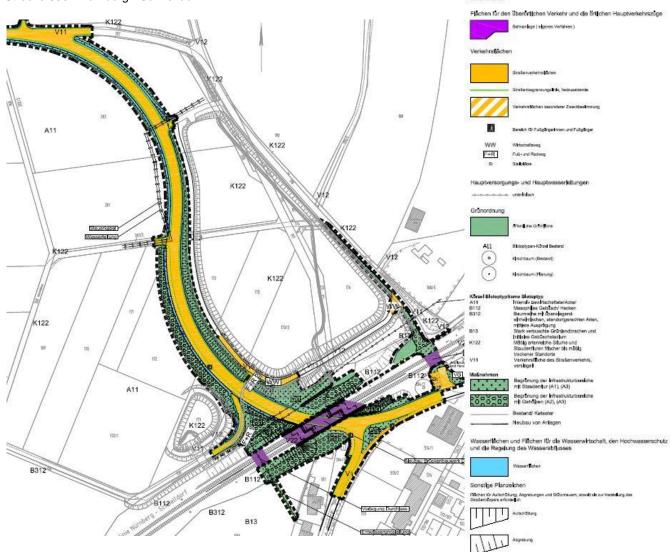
Bebauungsplan zum geplanten Vorhaben - Stand 24.04.2017
